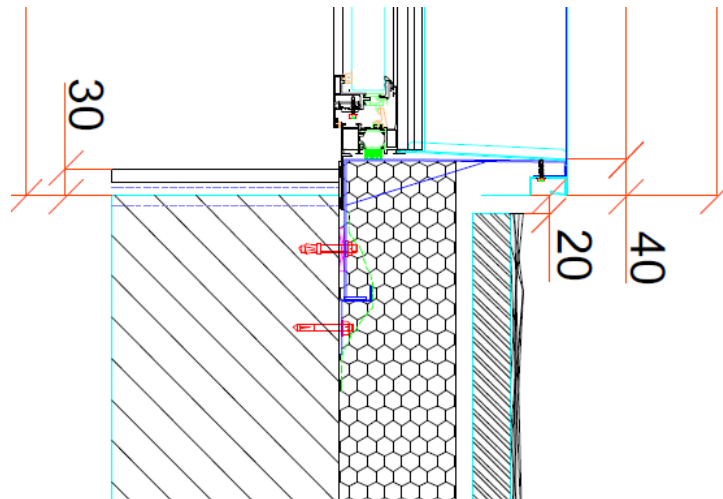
Pormenor da interseção do revestimento com o sistema de envidraçado
